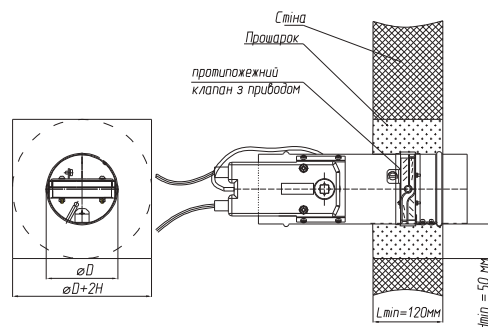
Схема монтажу клапана КПВ круглого перерізу в огорожувальних конструкціях
